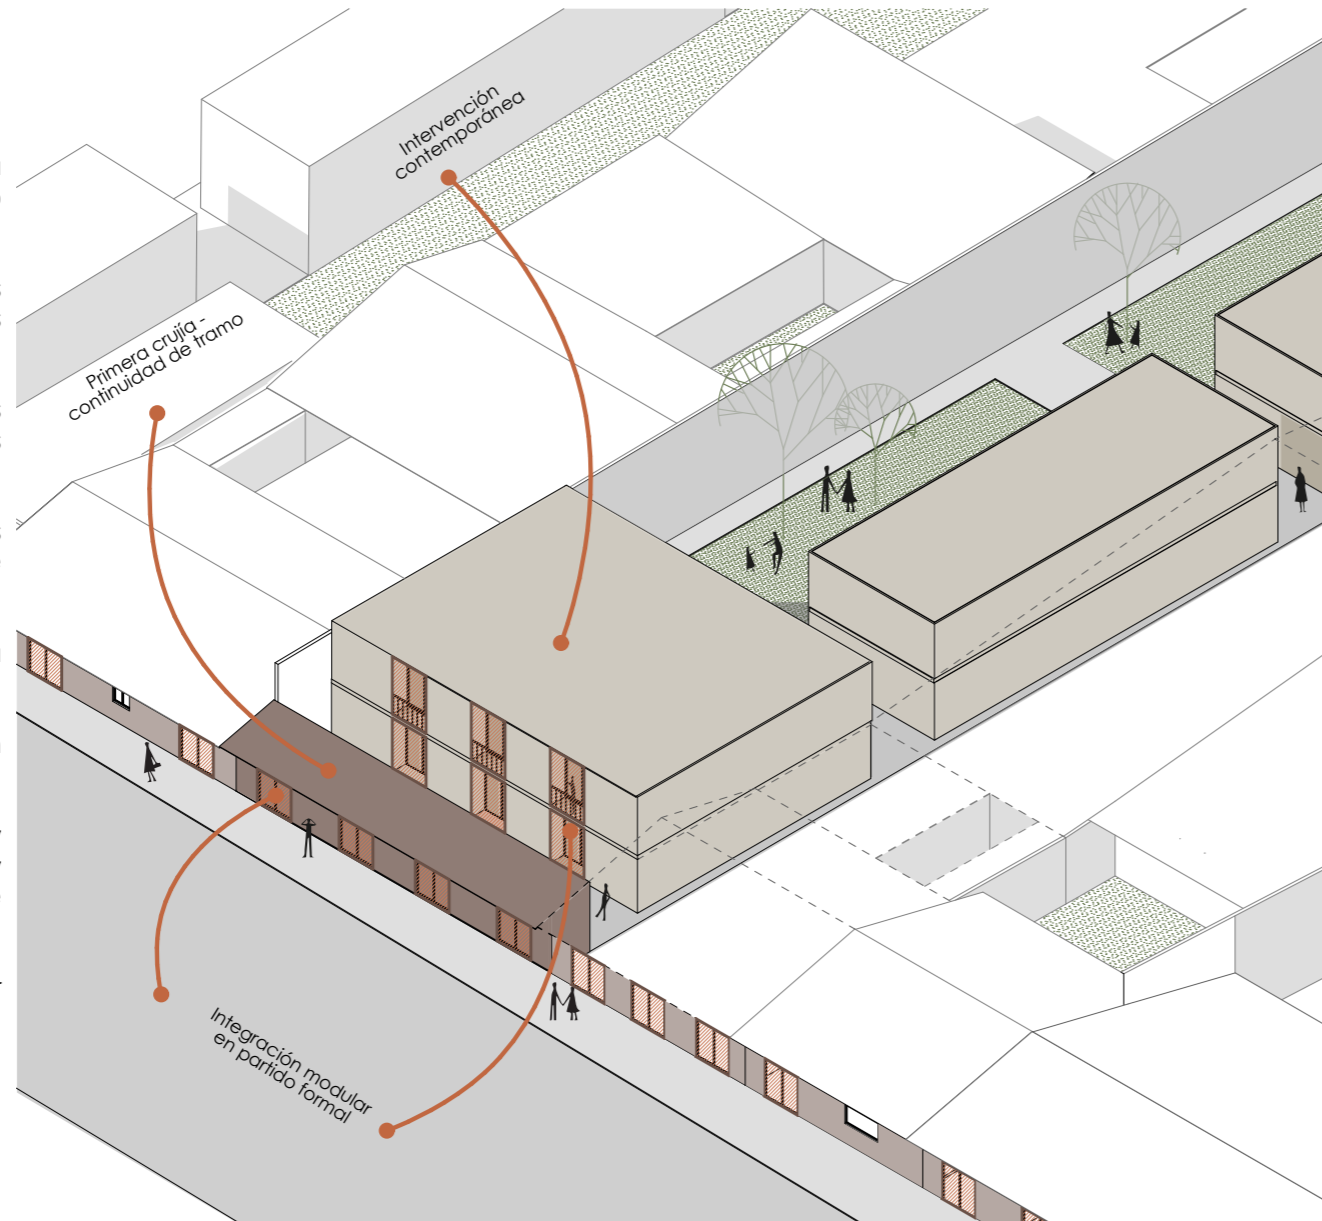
Axonometría conceptual: continuidad de crujía e integración modular. Autoría propia.
